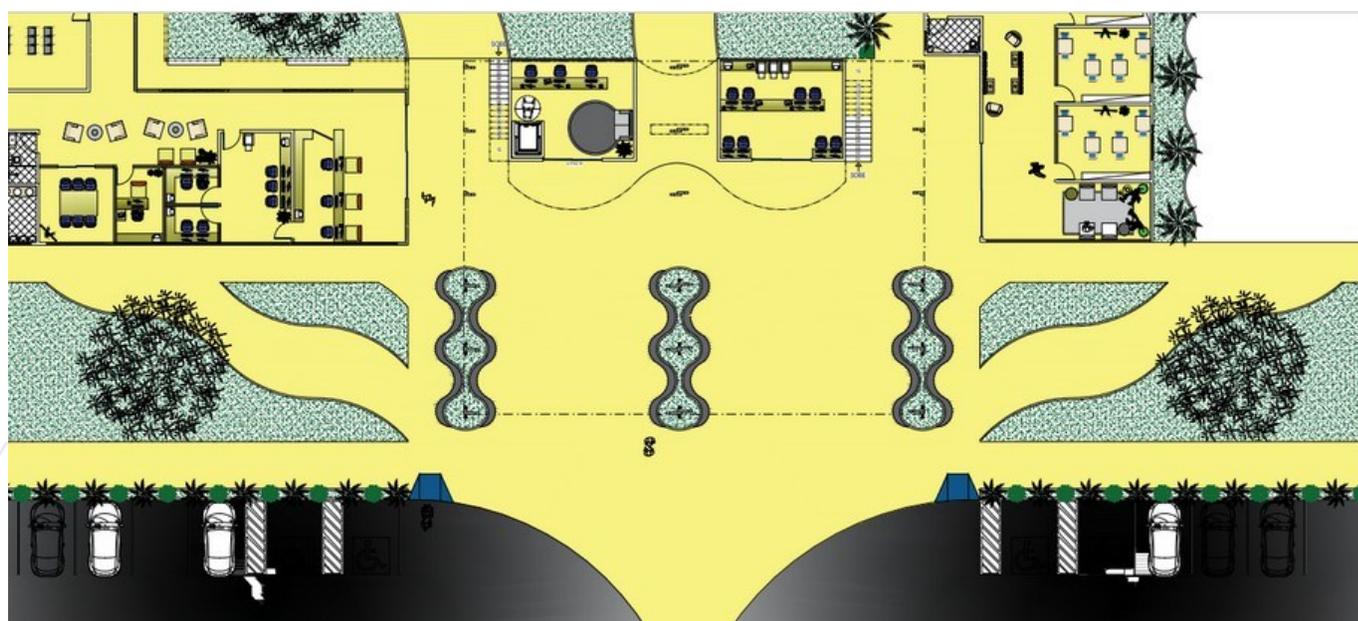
Planta de Layout Ampliada. Fonte: pelo autor (2023).
